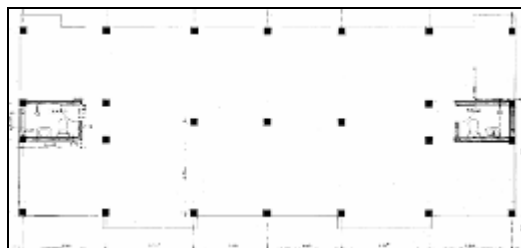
c. Vivienda T-1 Variante Catia La Mar. Planta
